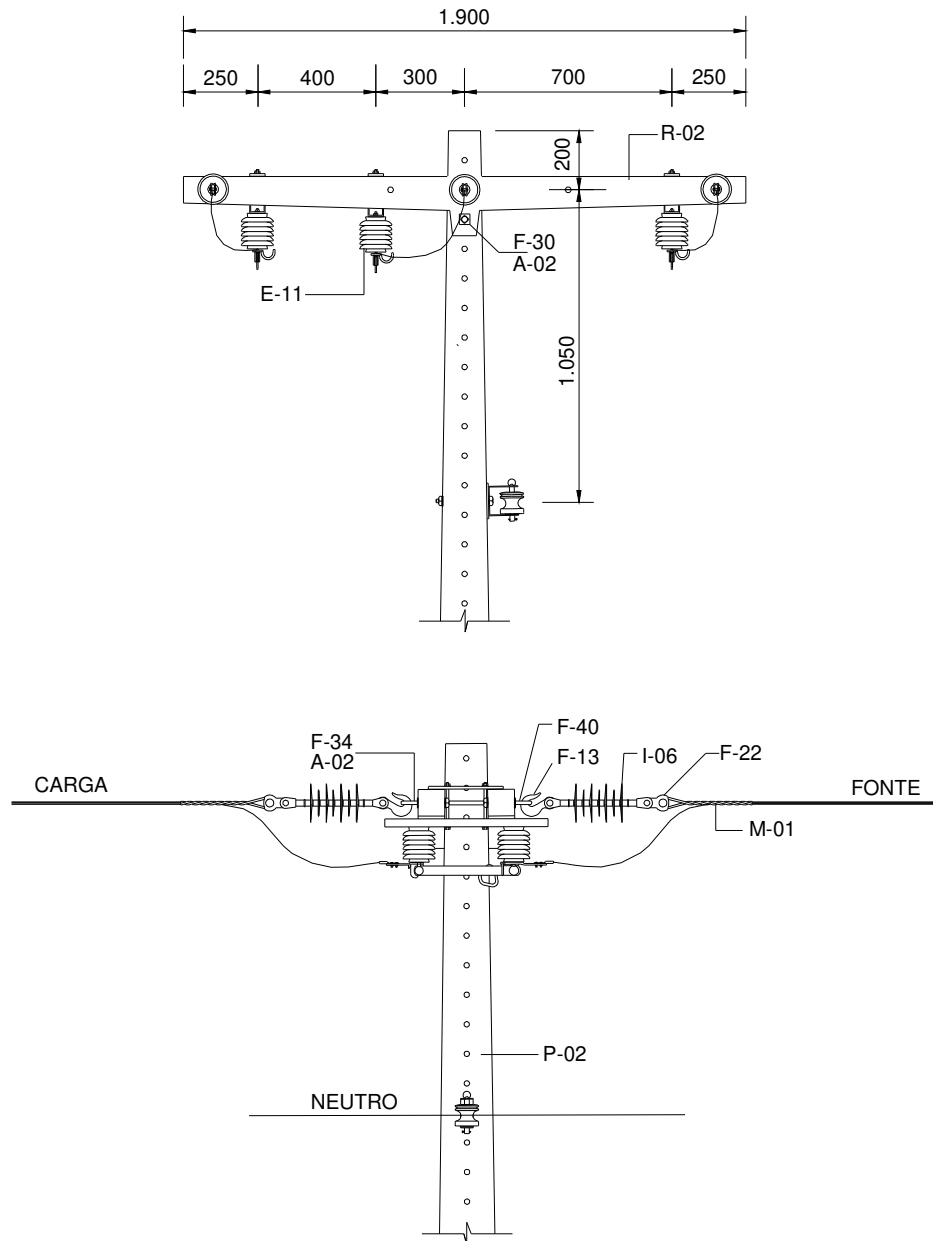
Instalação de equipamentos – Chave faca em alinhamento
